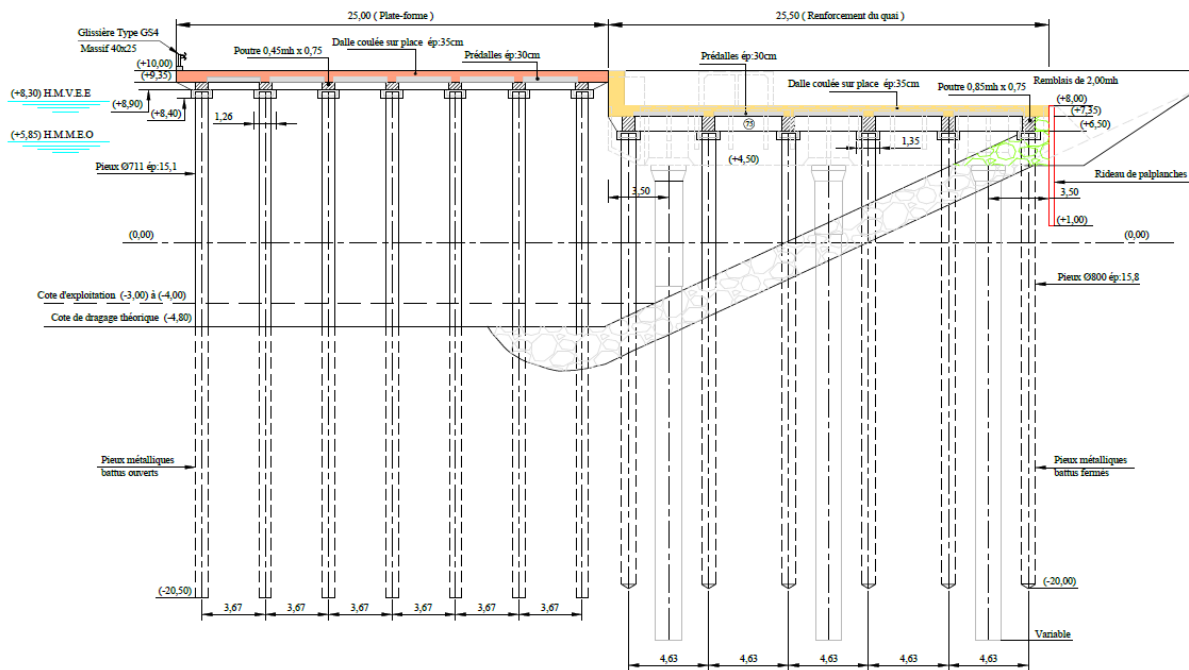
Coupe du renforcement du quai et de la rampe Roro
